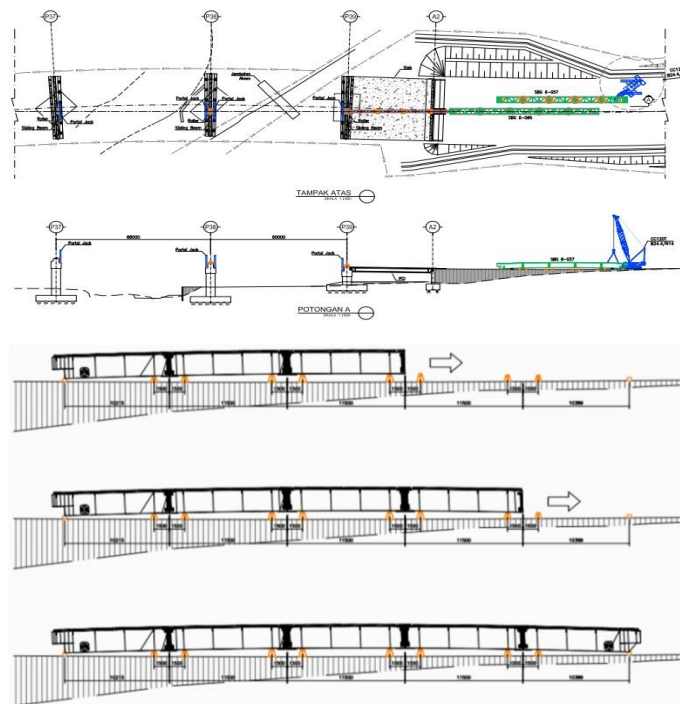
Ilustrasi Pemasangan Steel Tub Girder 65 m
